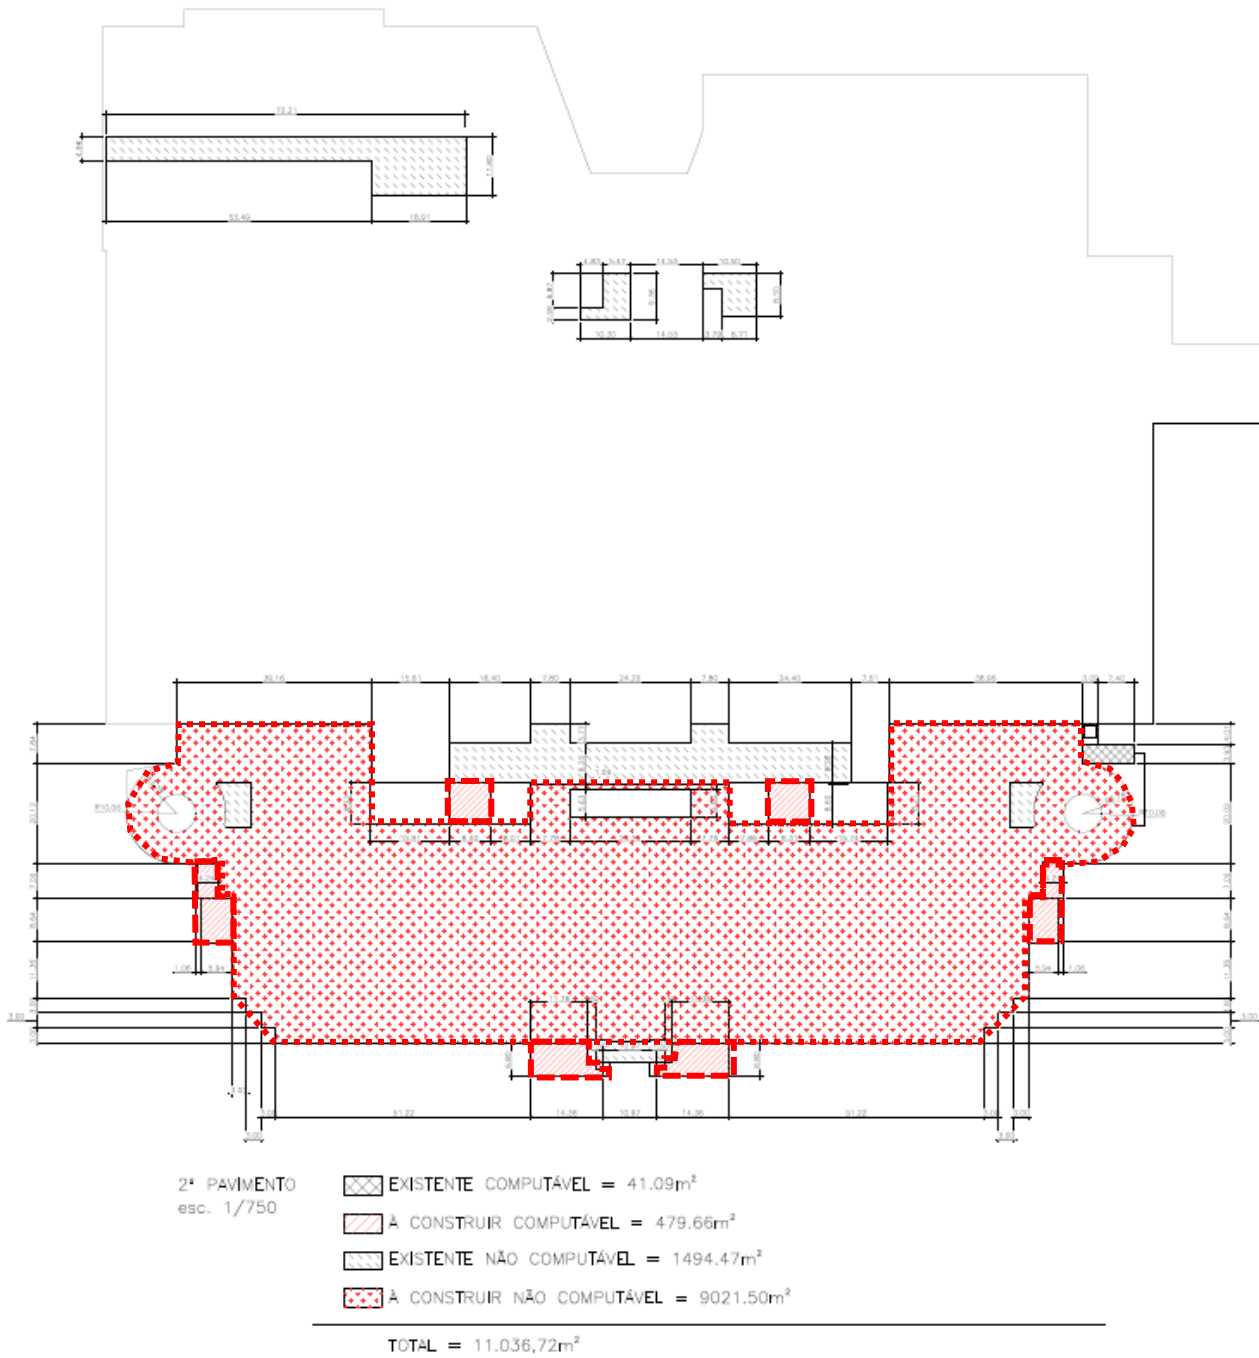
Segundo pavimento. Fonte: Engexpor.
